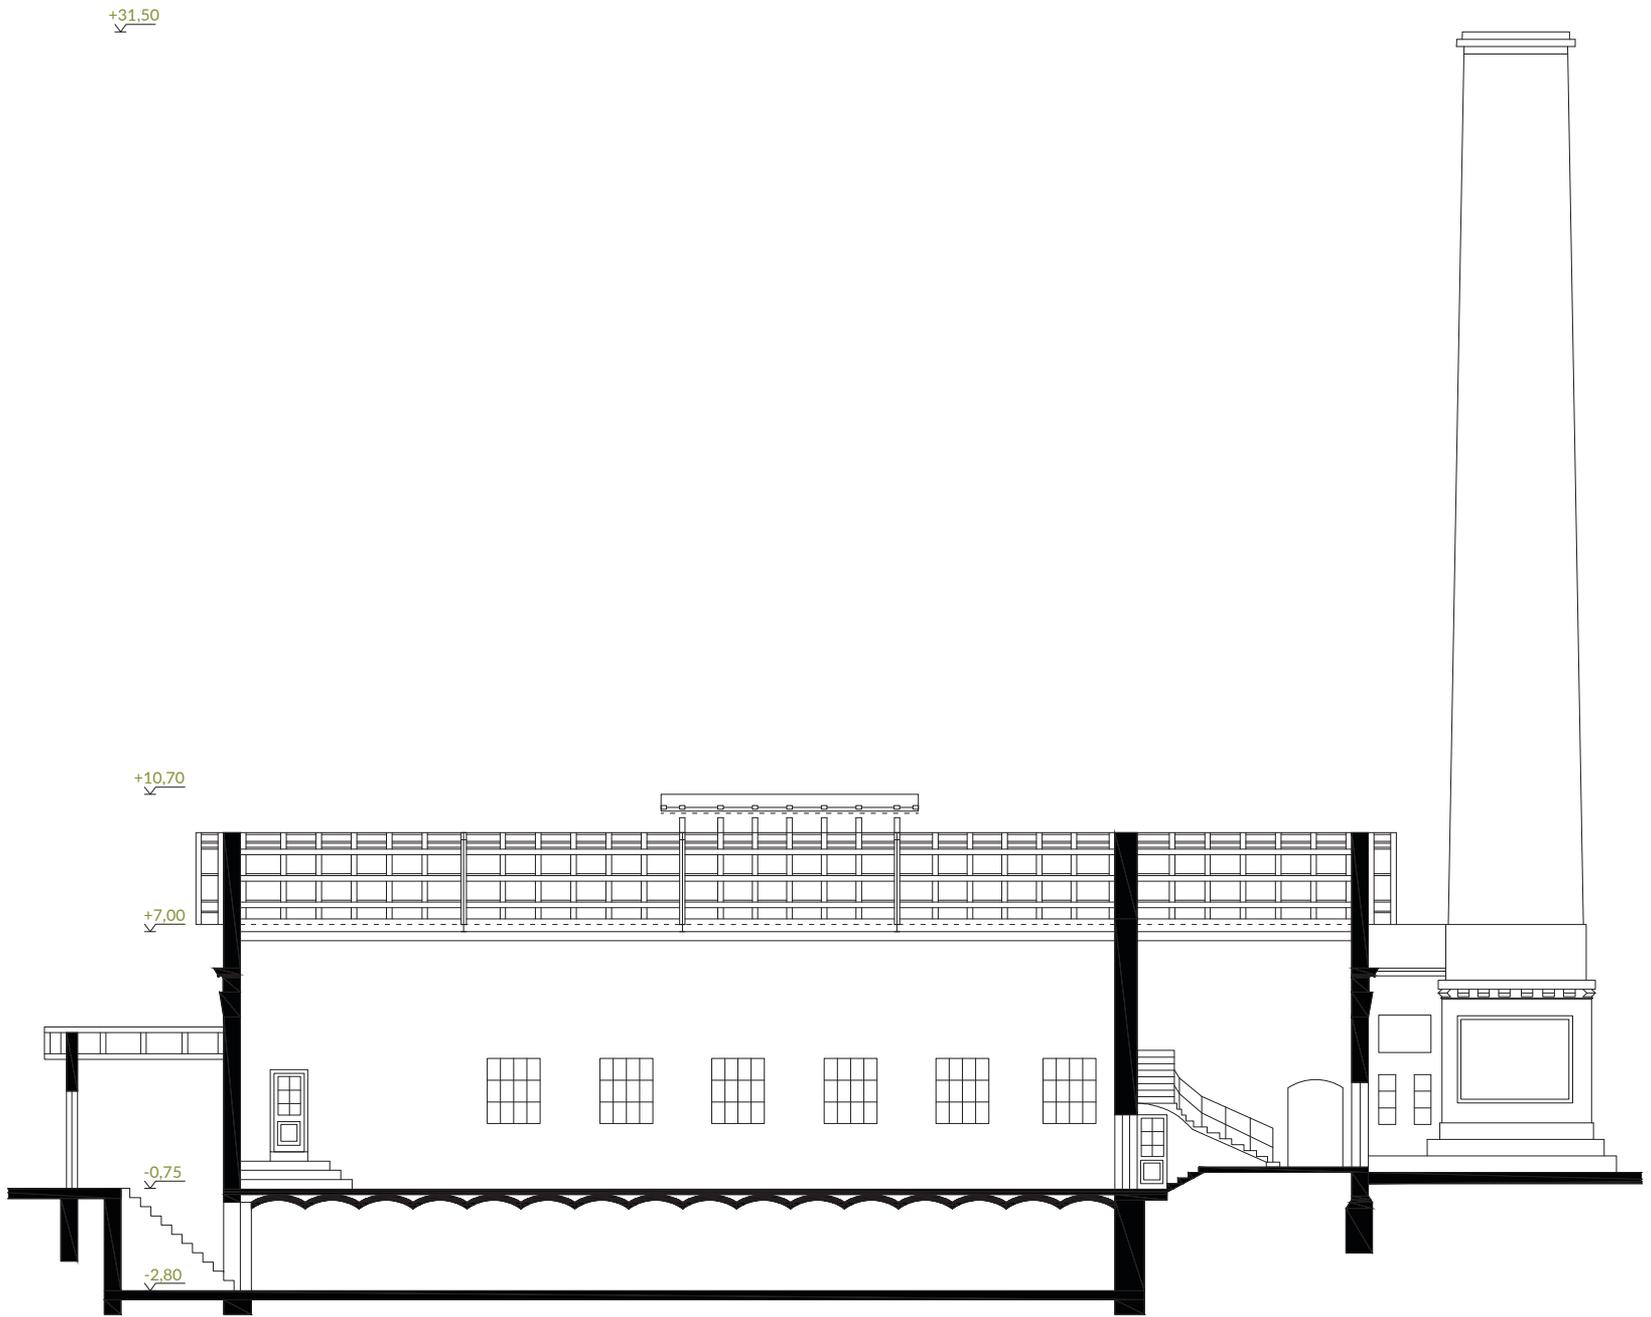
Schnitt 4-4 M 1:200 (Stand 1885)
